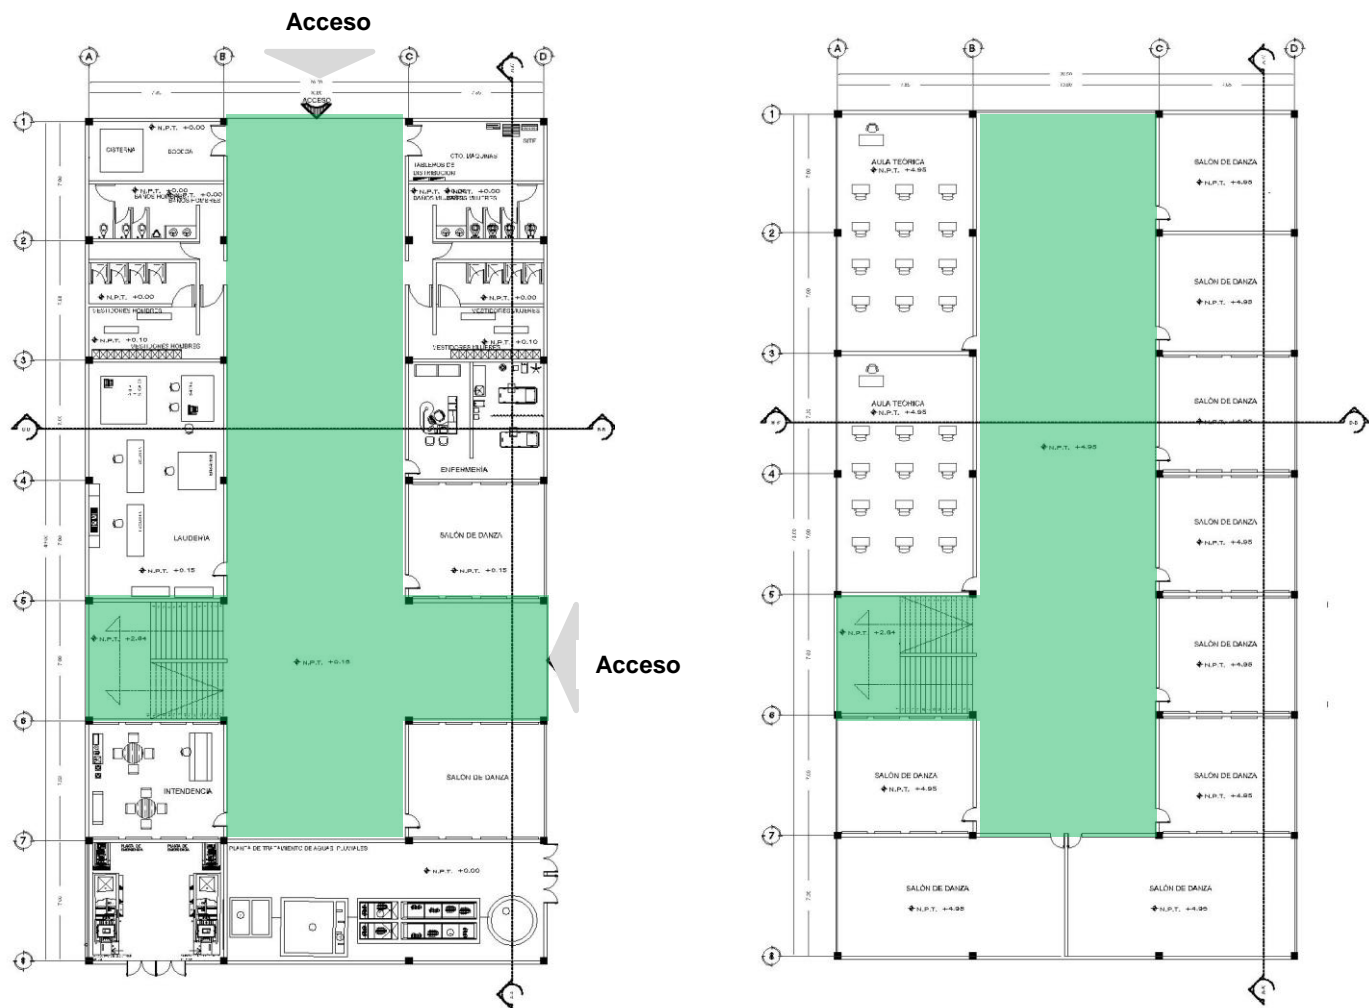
Planta edificio de danza destacando los locales de enseñanza y servicio.
